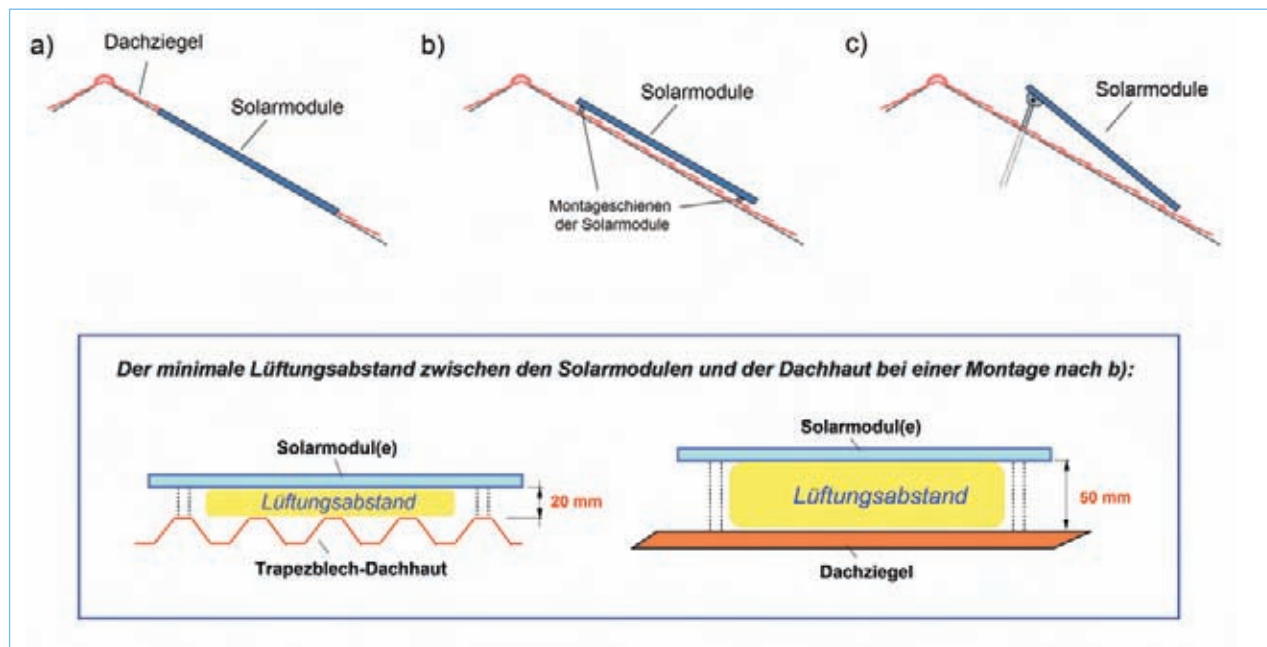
Solarmodule können an einem Dach auf drei Grundarten montiert werden: a) in die Dachhaut integriert (Indach-Montage), b) mit mindestens 5 cm Lüftungsabstand zu der Dachhaut (Aufdach-Montage) oder c) mit einem (eventuell verstellbarem) Neigungswinkel, der von der Dachneigung abweicht bzw. auf nicht verstellbare Konsolen auf Flachdächern.
